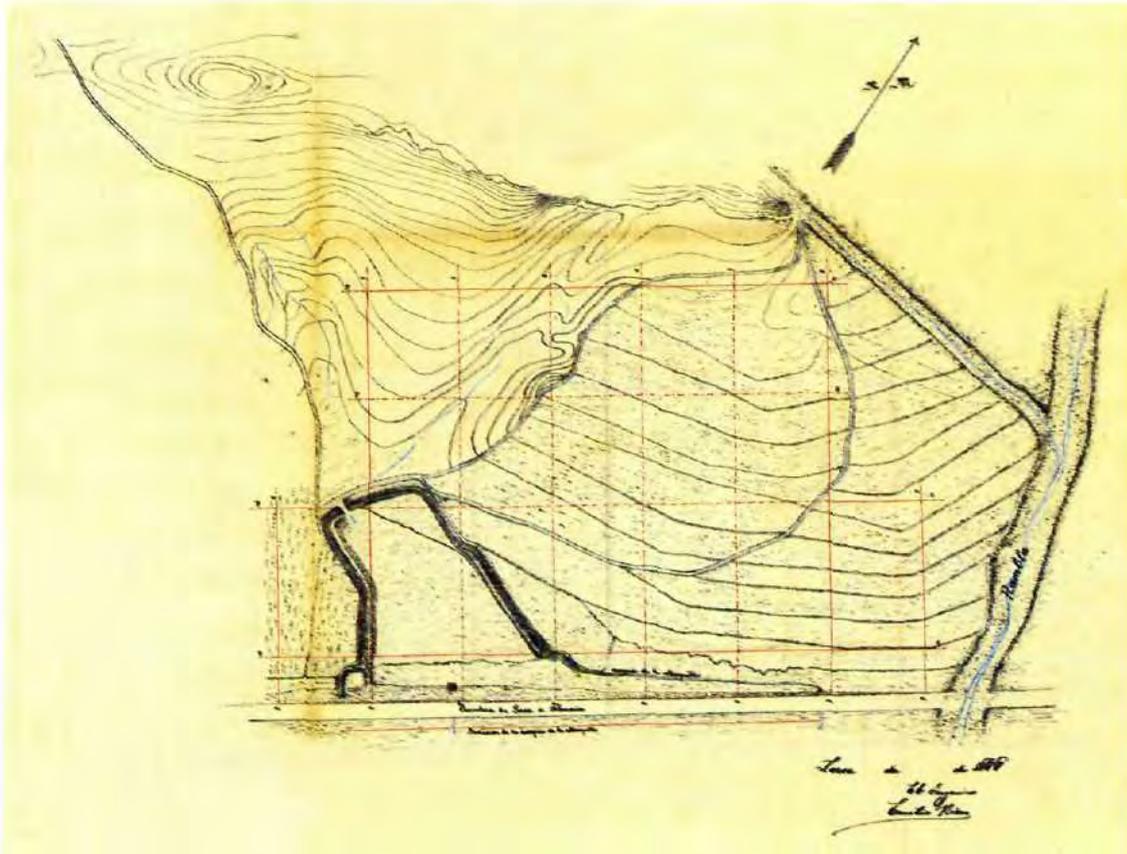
Plano de situación del cementerio. Ingeniero Riera. 1888
